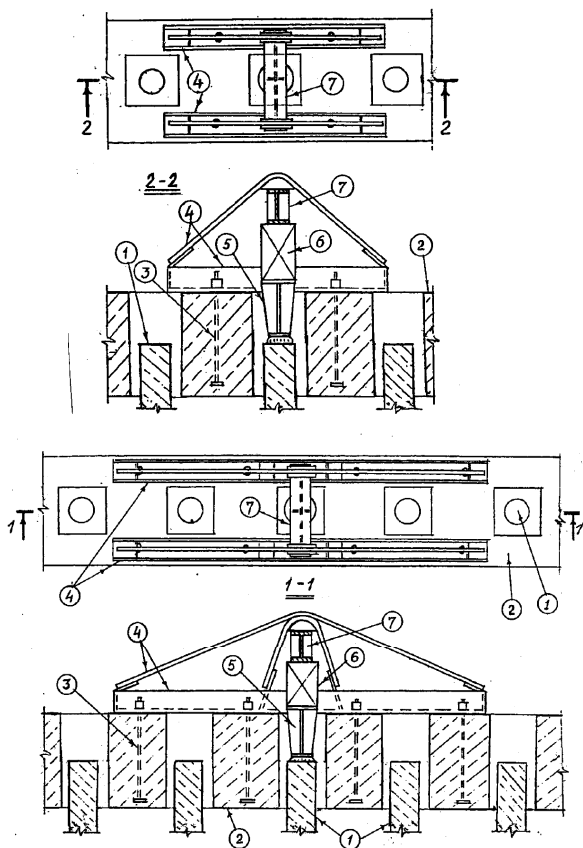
Схемы силовых установок для испытаний и «обжатия» свай:
